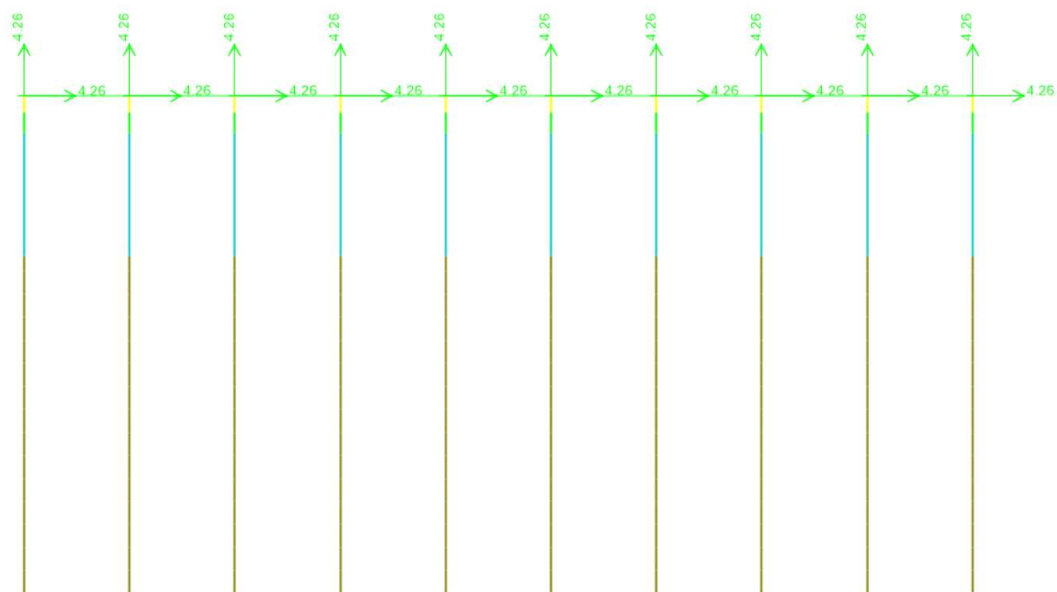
Joint Masses de pilotes verticales - Eje E (4.26 kN-s²/m)
